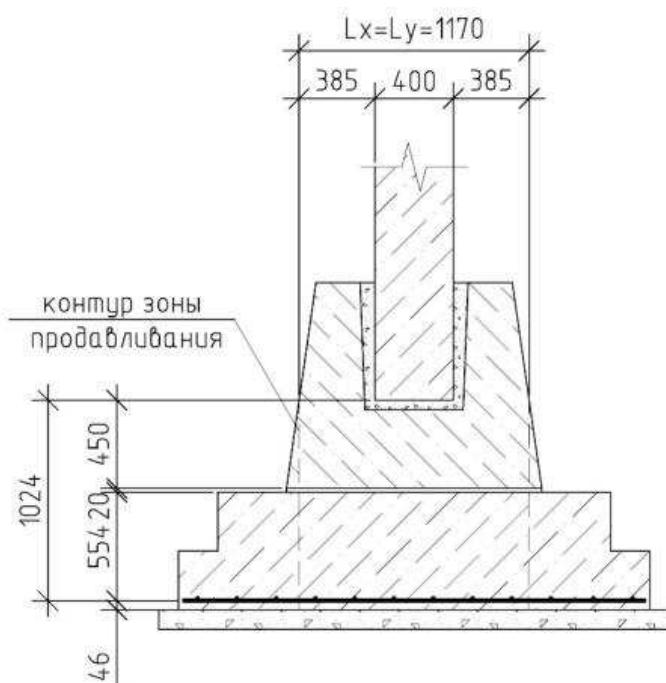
Расчетное сечение сборно-монолитного фундамента
